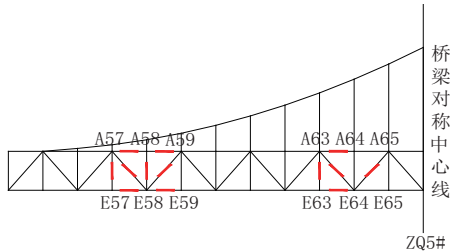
顶推施工过程中主桁受力较不利处应力监测断面布置图
